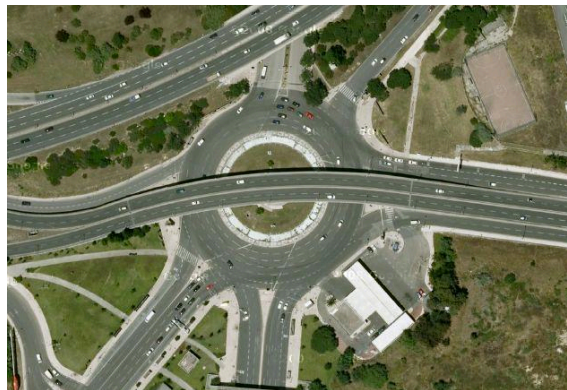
Vista em planta do Viaduto da Praça do Relógio
